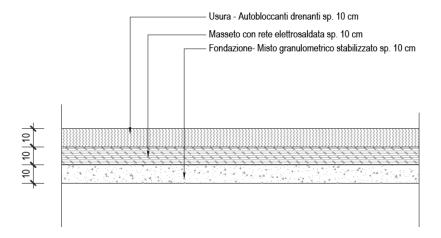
Pacchetto pavimentazione stalli parcheggio
